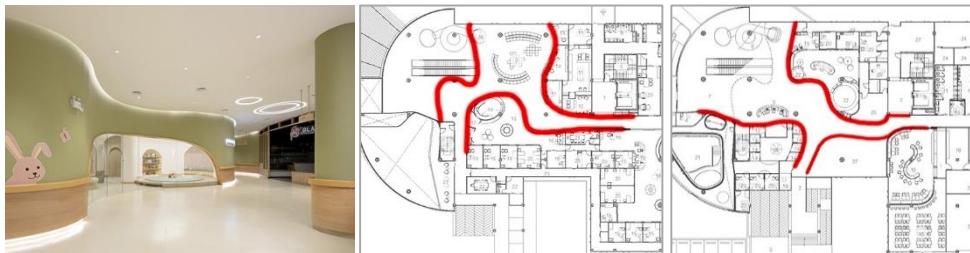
مخطط الطابق الأرضي لمراكز EKH لطب الأطفال - المصادر: www.archdaily.com بتصرف الباحث
